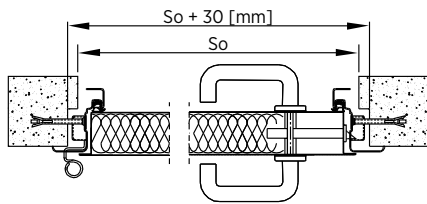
Pose entre murs d'un bloc-porte à un battant avec bâti angulaire - coupe horizontale
